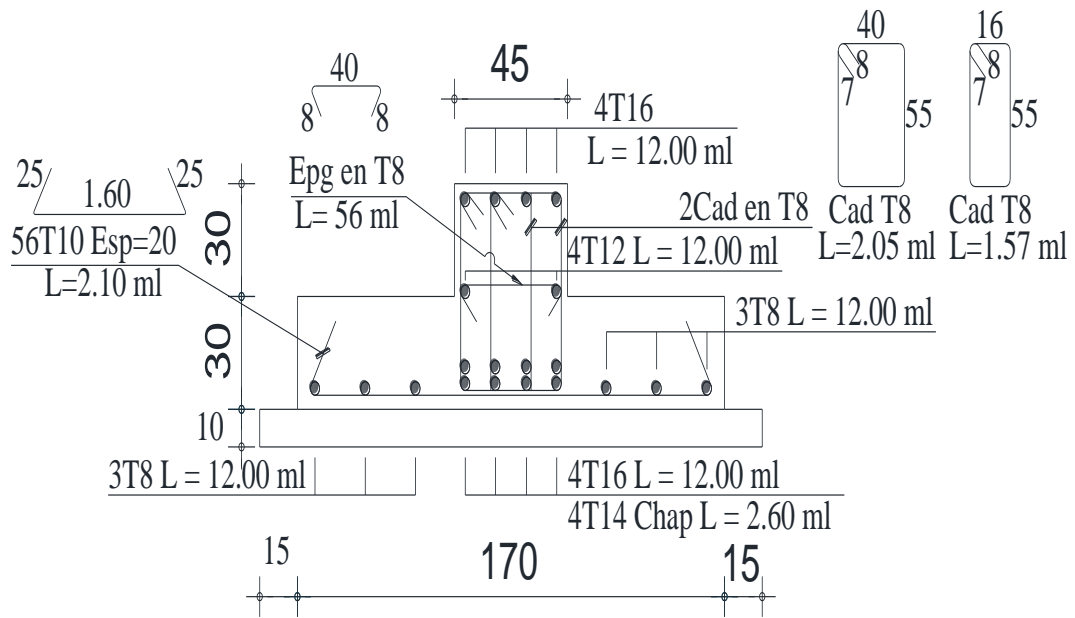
schéma de ferrailage des semelles aux appuis
